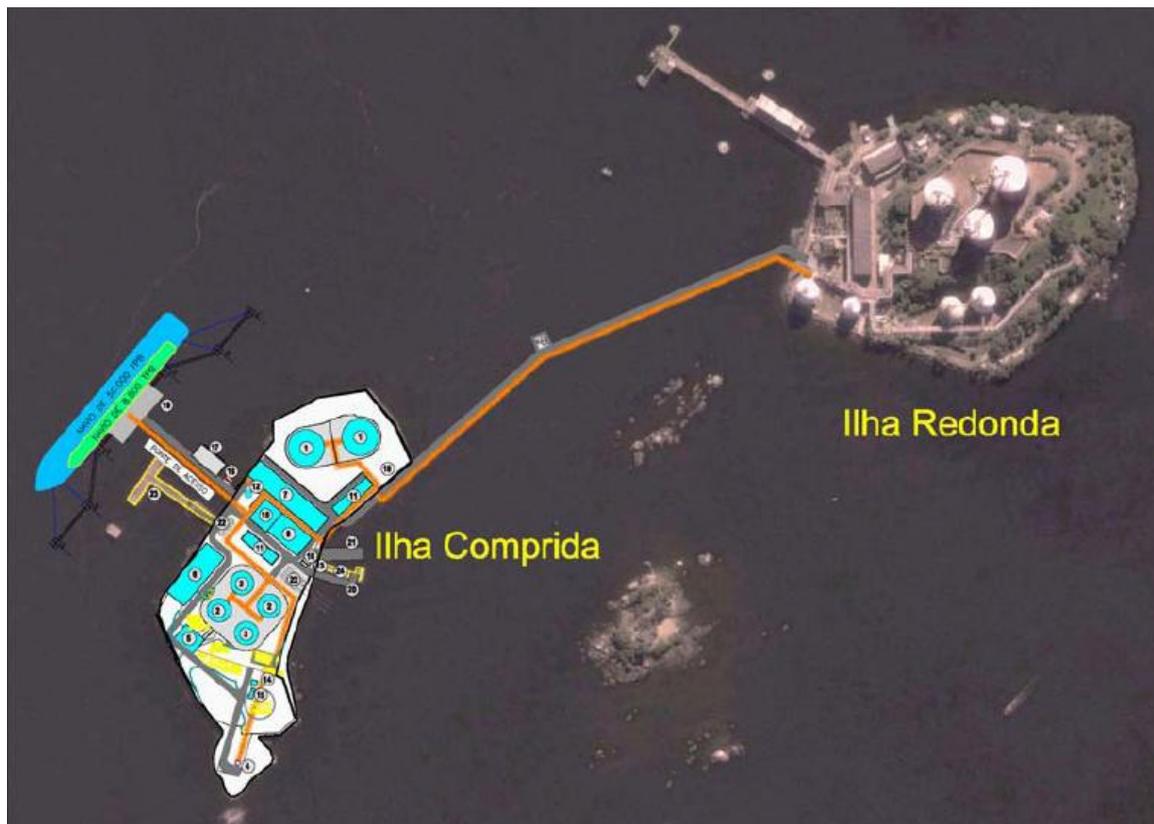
Arranjo das Estruturas dos Terminais da Ilha Comprida e da Ilha Redonda
